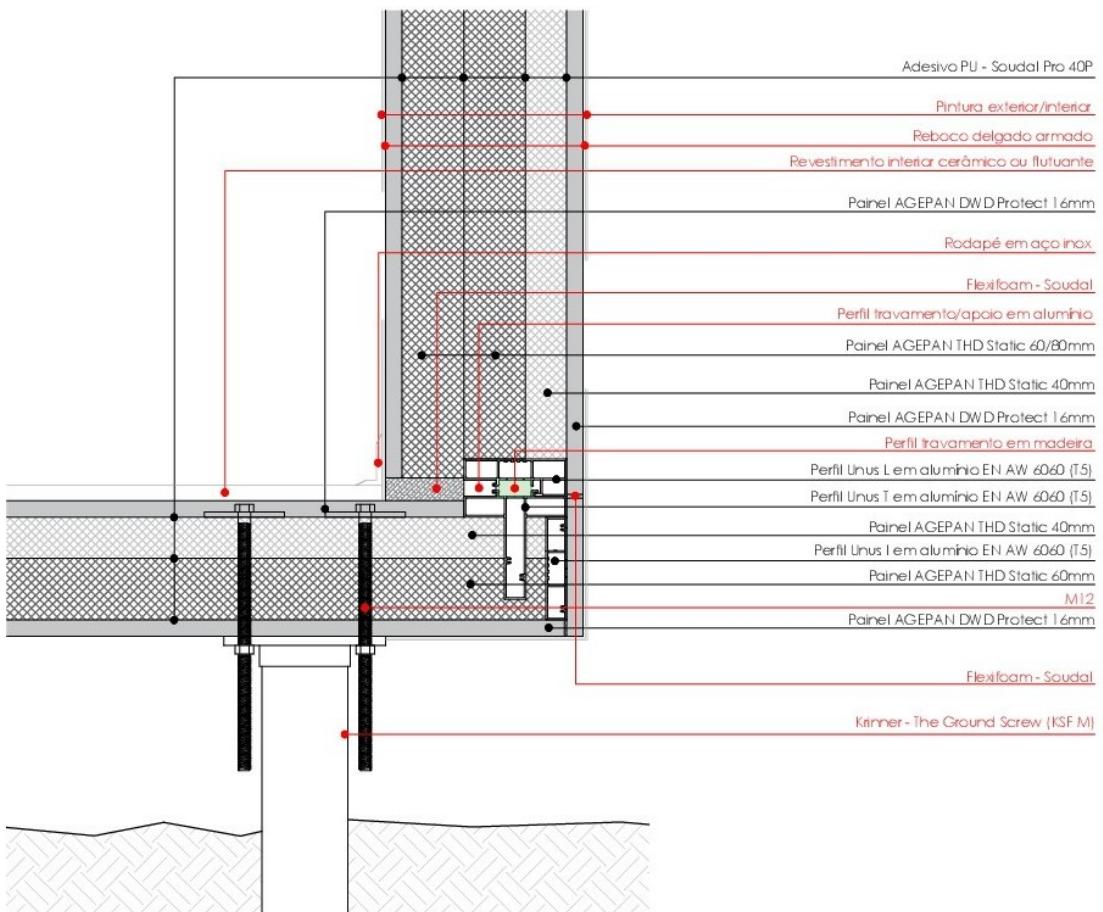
Solução AGEPAN – Pormenor Construtivo de Pisos/ Paredes II.
